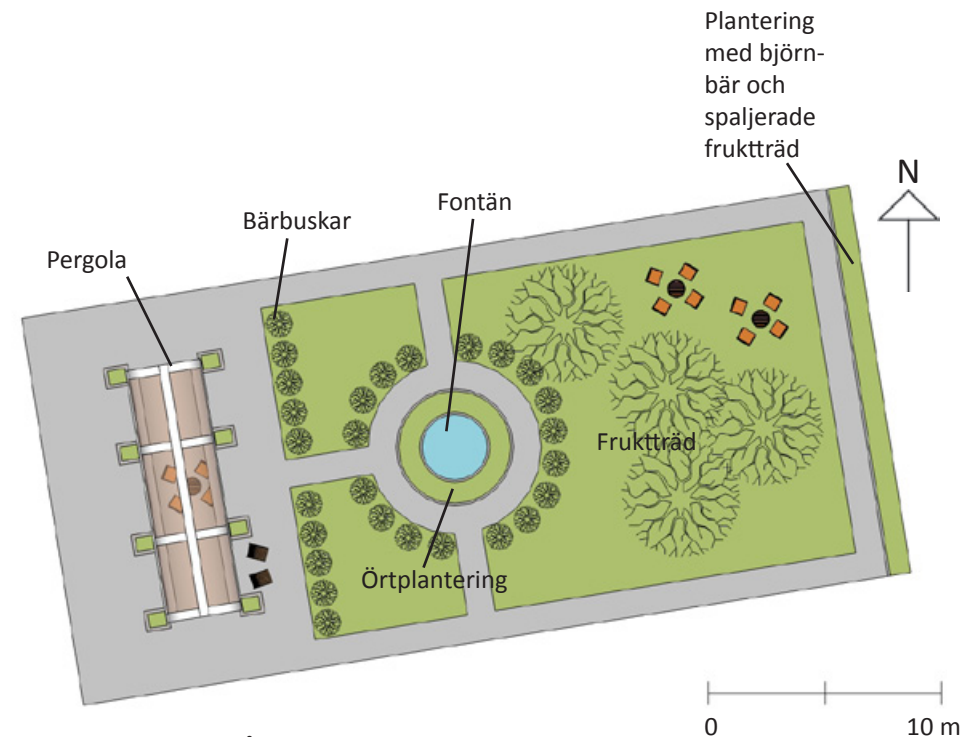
Plan över innergården. Illustration: Fanny Jacobsson
